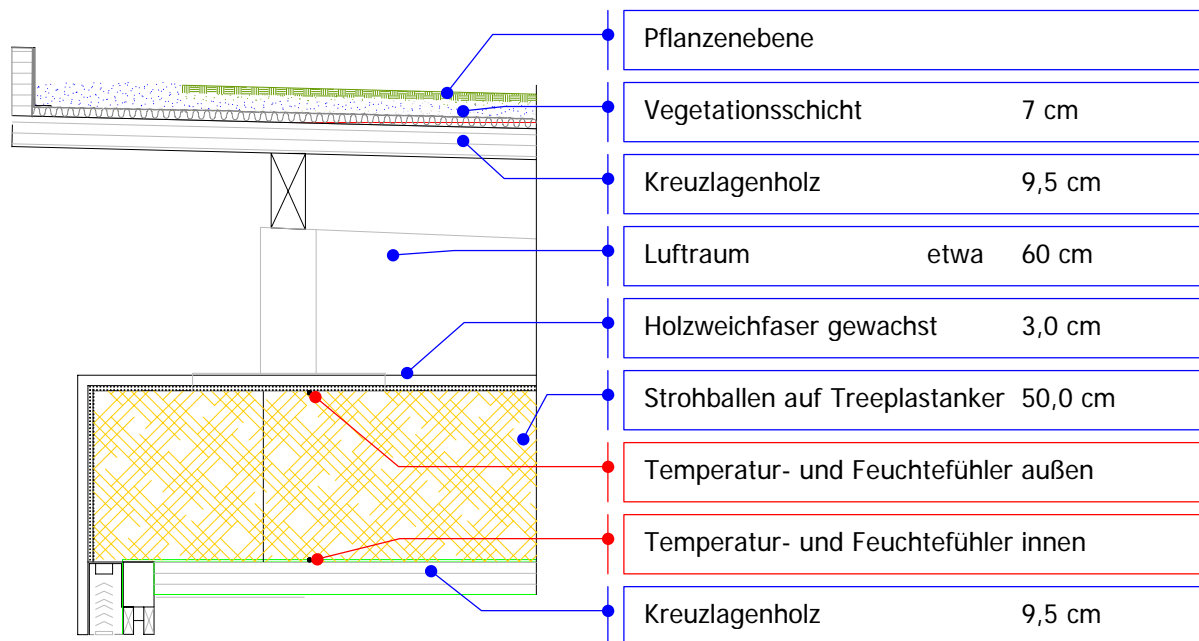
Deckenaufbau mit Einbaulage der Sensoren
